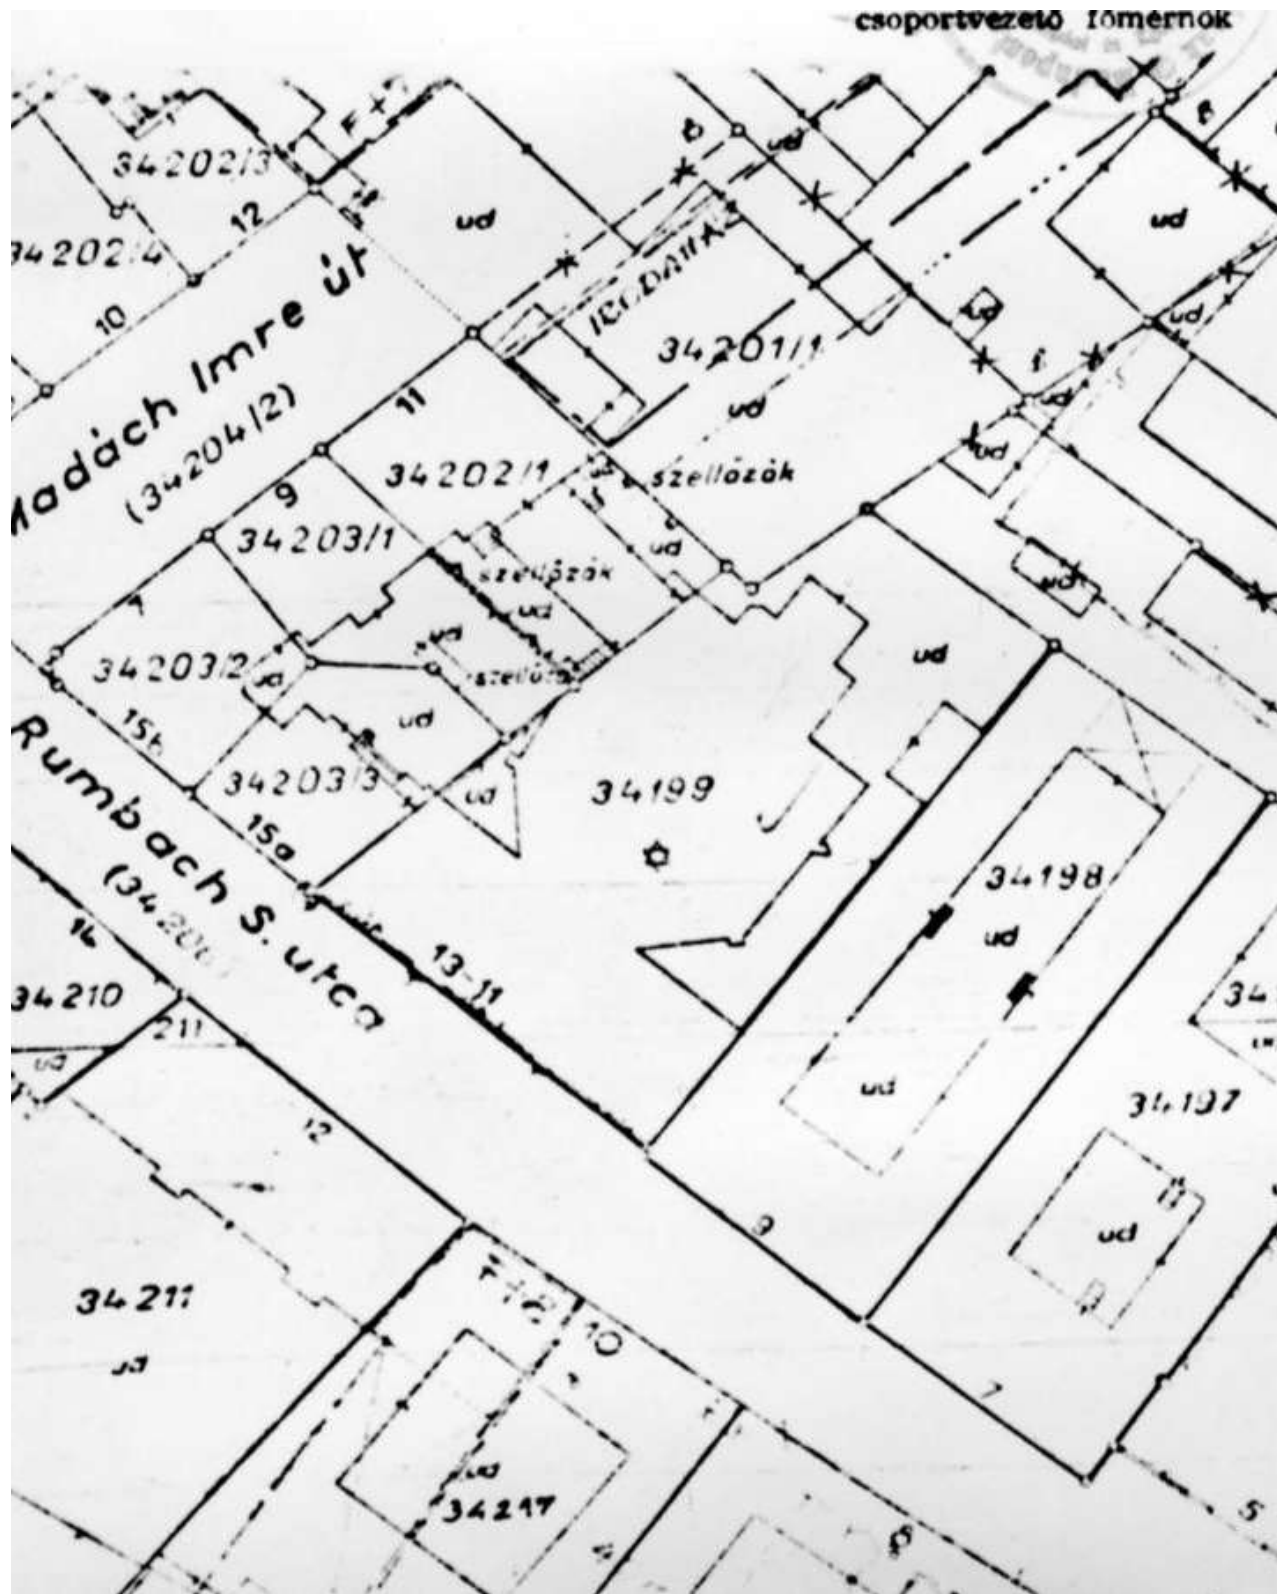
Ausschnitt aus dem offiziellen Lageplan 1981
